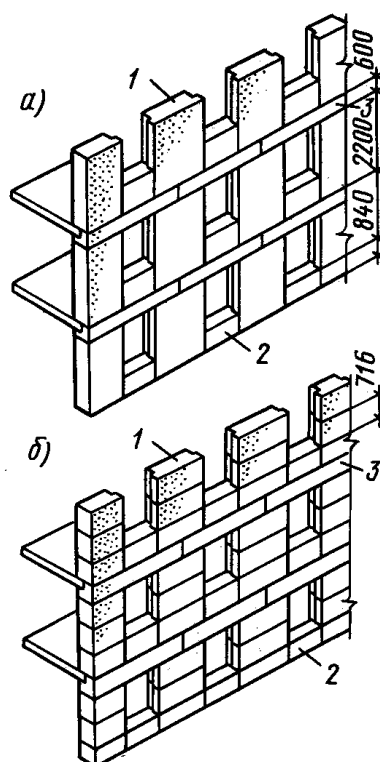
Схемы разрезки стен крупноблочных зданий:
